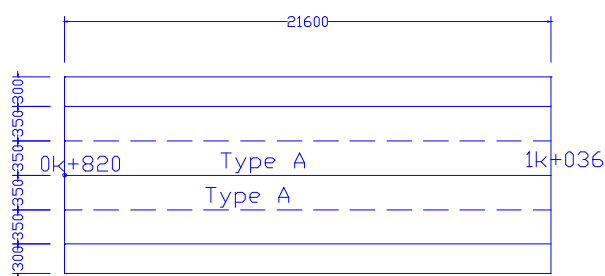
轉爐石密級配瀝青混凝土鋪設平面示意圖
